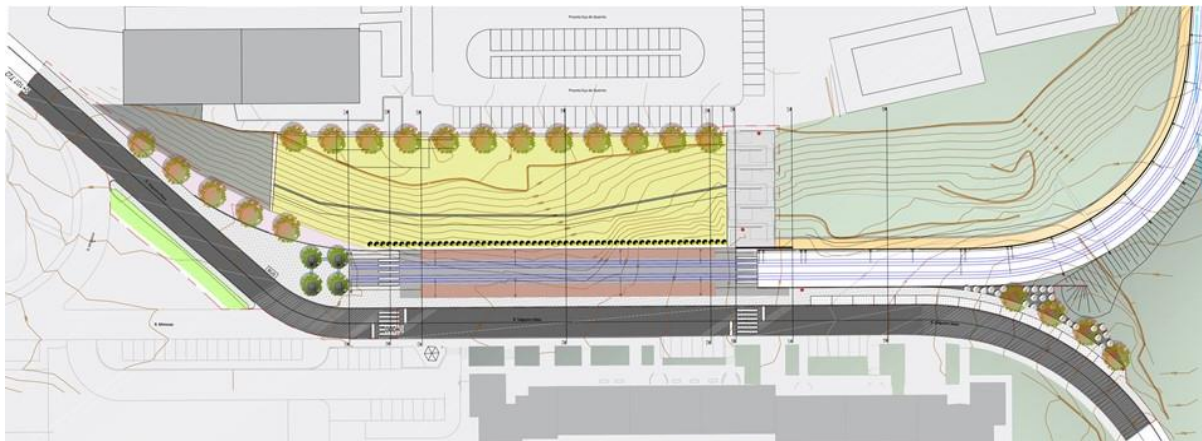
Plano geral de proposta de intervenção para a estação de Vila d'Este
